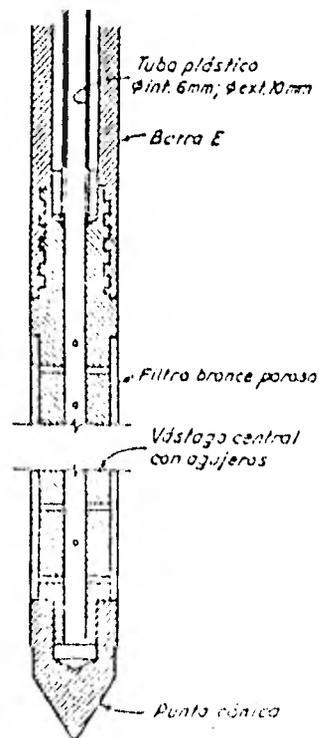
Piezómetro abierto tipo Geonor (según Bjerrum et al., 1965).
